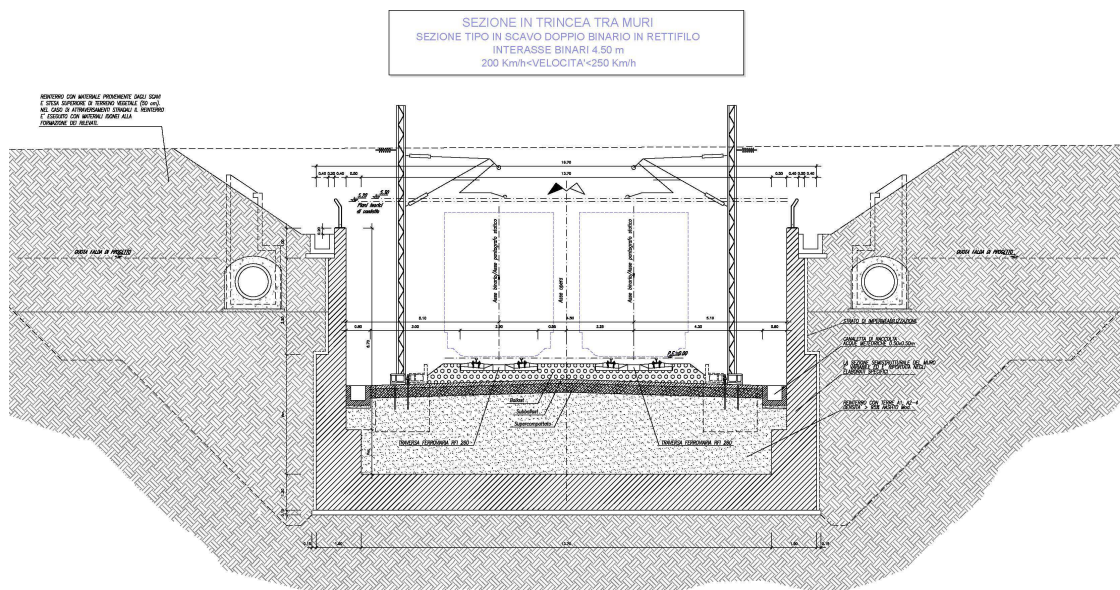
Sezione in trincea con muri di contenimento a “U” – Progetto Definitivo
